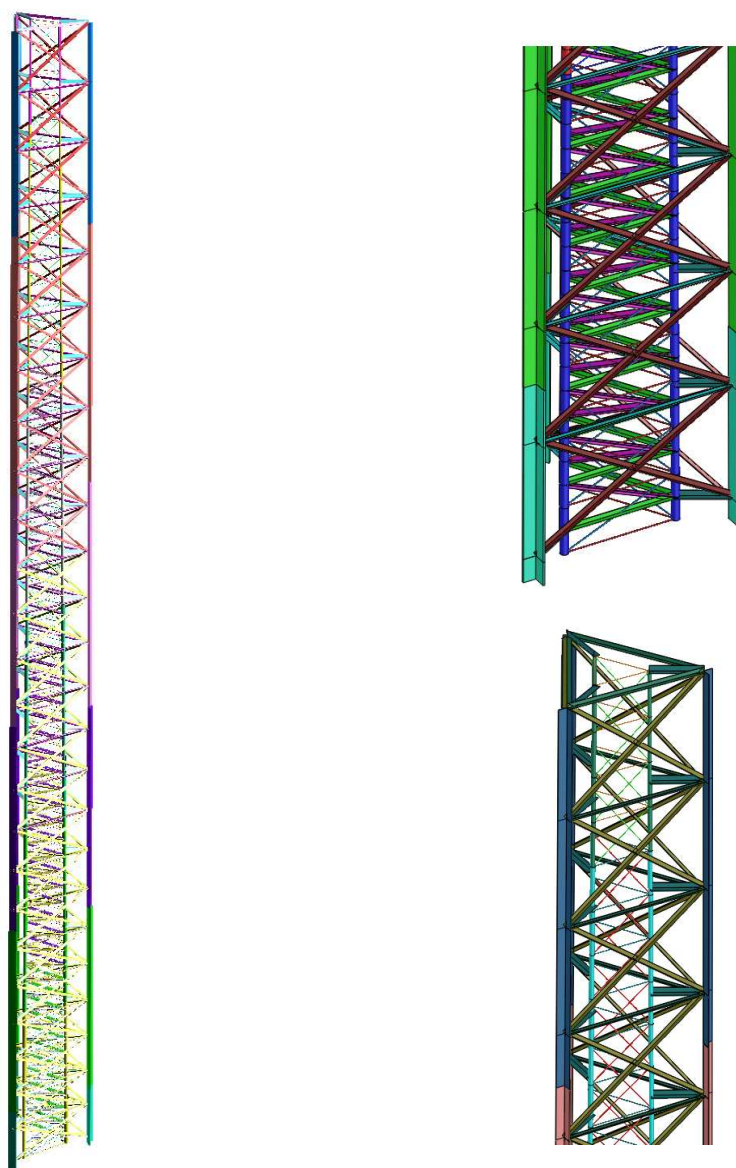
Reforço da estrutura – Silhueta / Base / Topo da estrutura.
